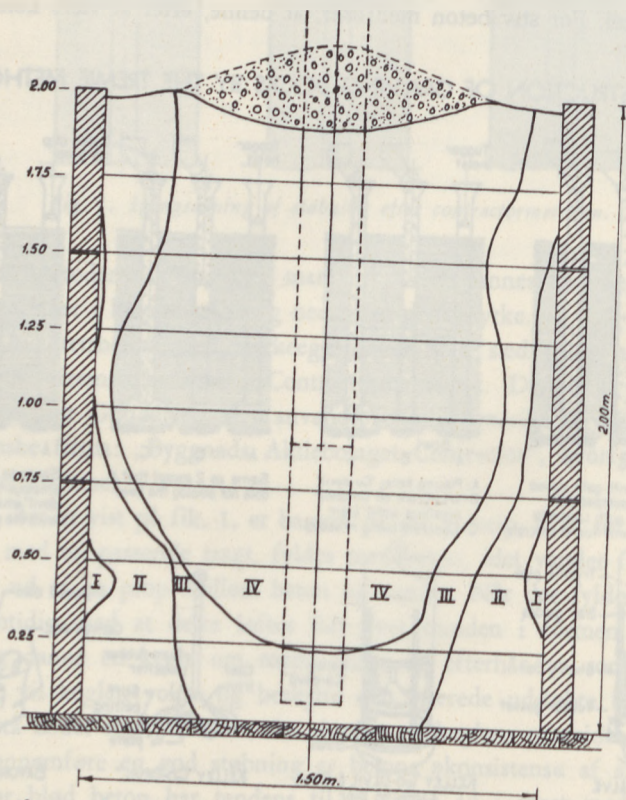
Prøvelegeme hvor linierne angiver skillelinier mellem forskelligt farvet beton.
